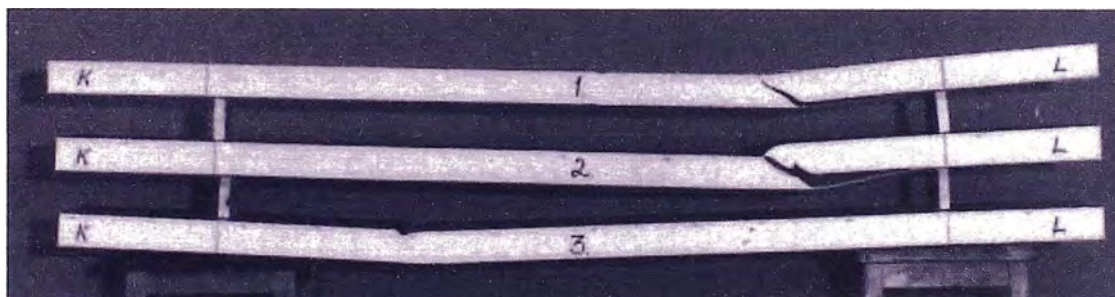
Probetas falladas del ensayo de corte. Falla al corte en muestras 1 y 2, falla por arrugamiento en la probeta 3
